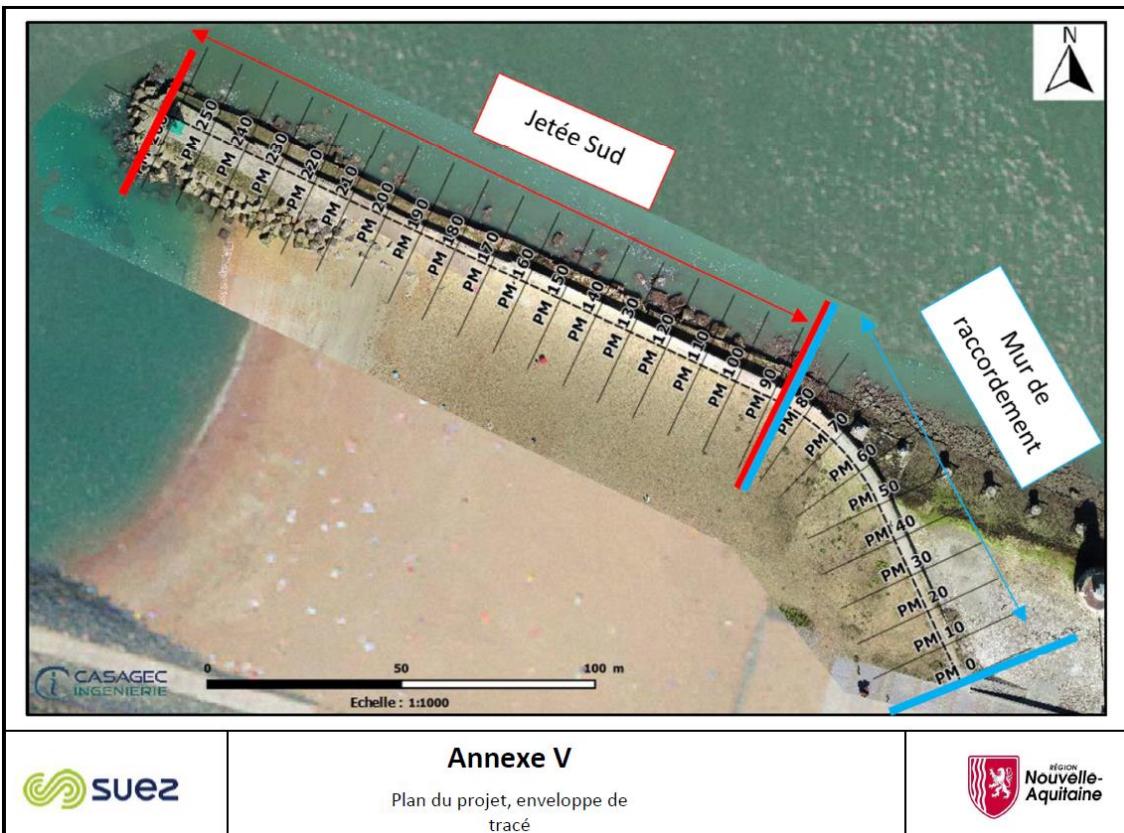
Plan du projet et enveloppe de tracé – Source : SUEZ Consulting, CASAGEC INGENIERIE
